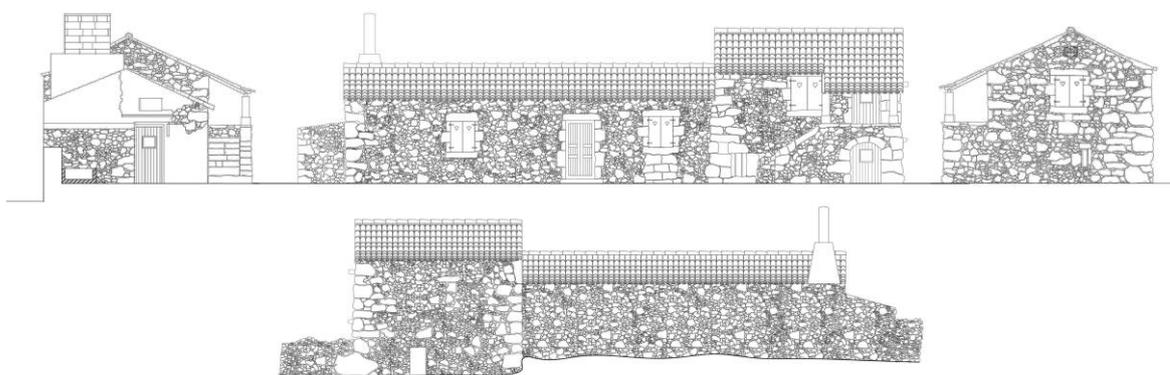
Levantamento arquitetónico. Alçados sul, nascente, norte e poente. Elaborado pelo autor.
